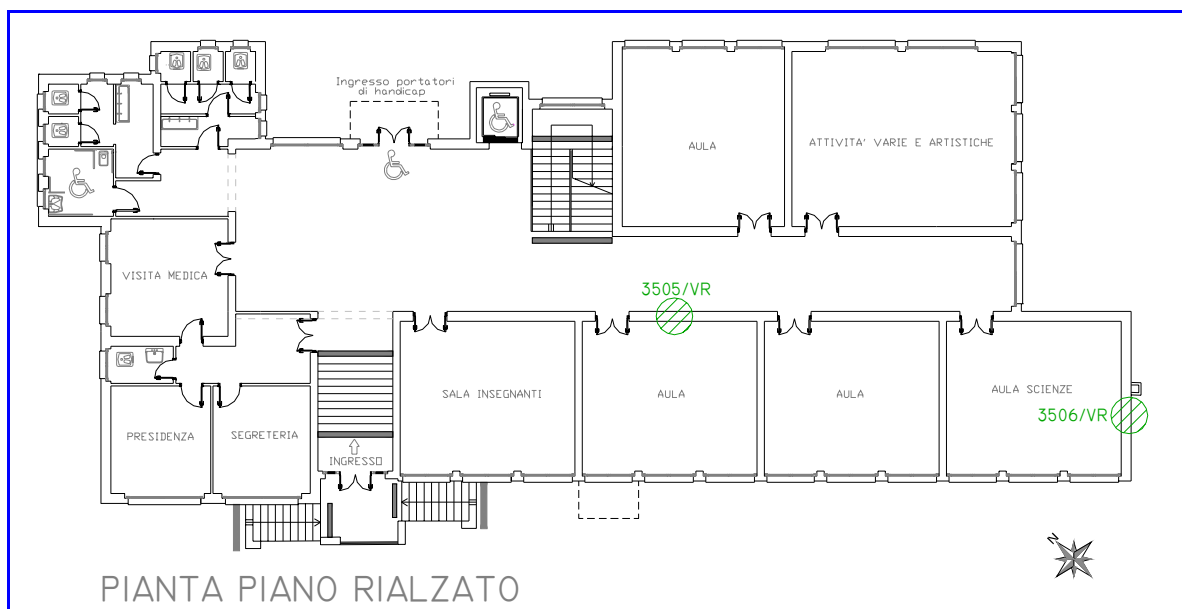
Planimetria piano rialzato con ubicazione prove con martinetti piatti
